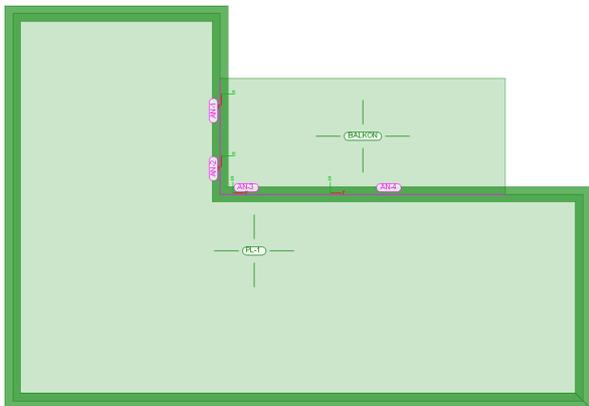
Zweiseitig gelagerte Balkonplatte mit Balkonanschluss-Positionen
